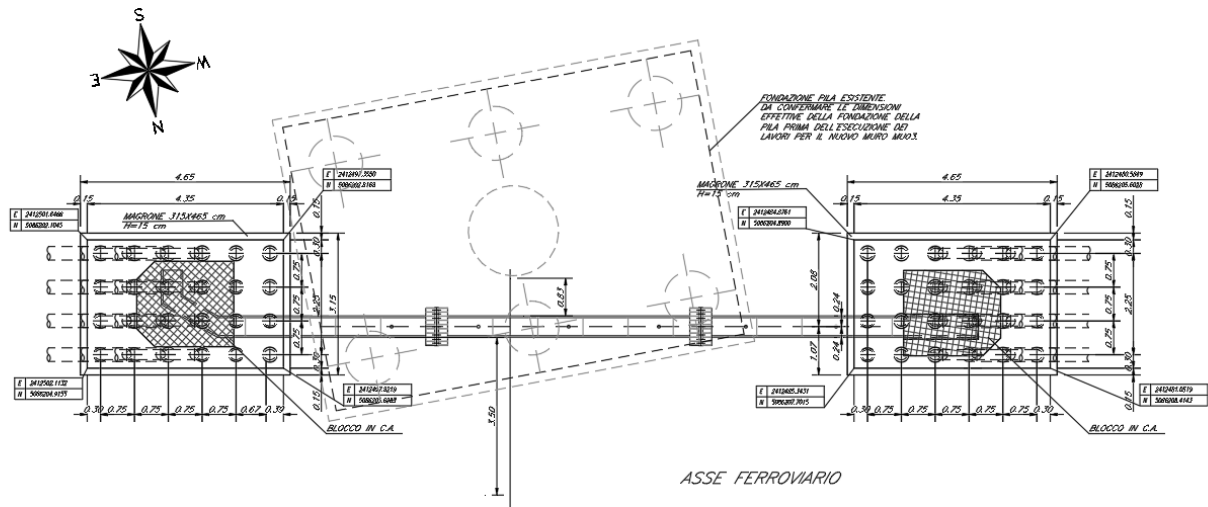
MU03 - planimetria generale muro opera di protezione con luce asse-asse di 17.00 m
